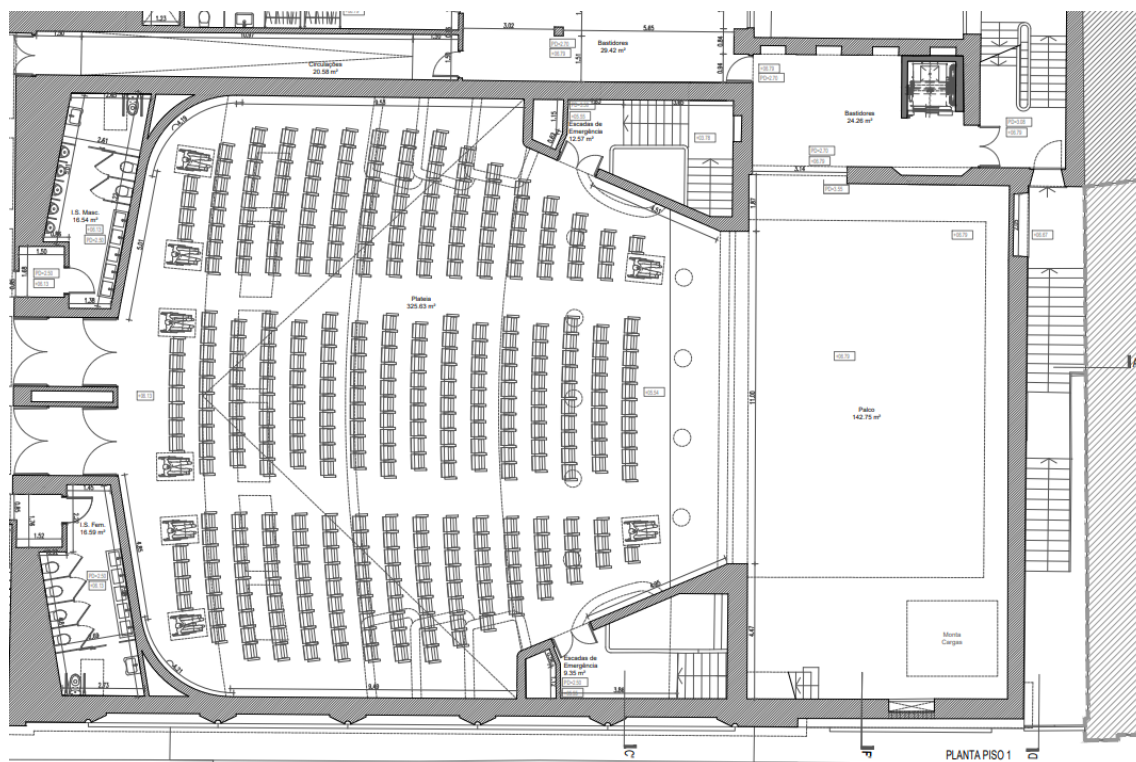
Planta do Piso 1 da sala principal. [33]
